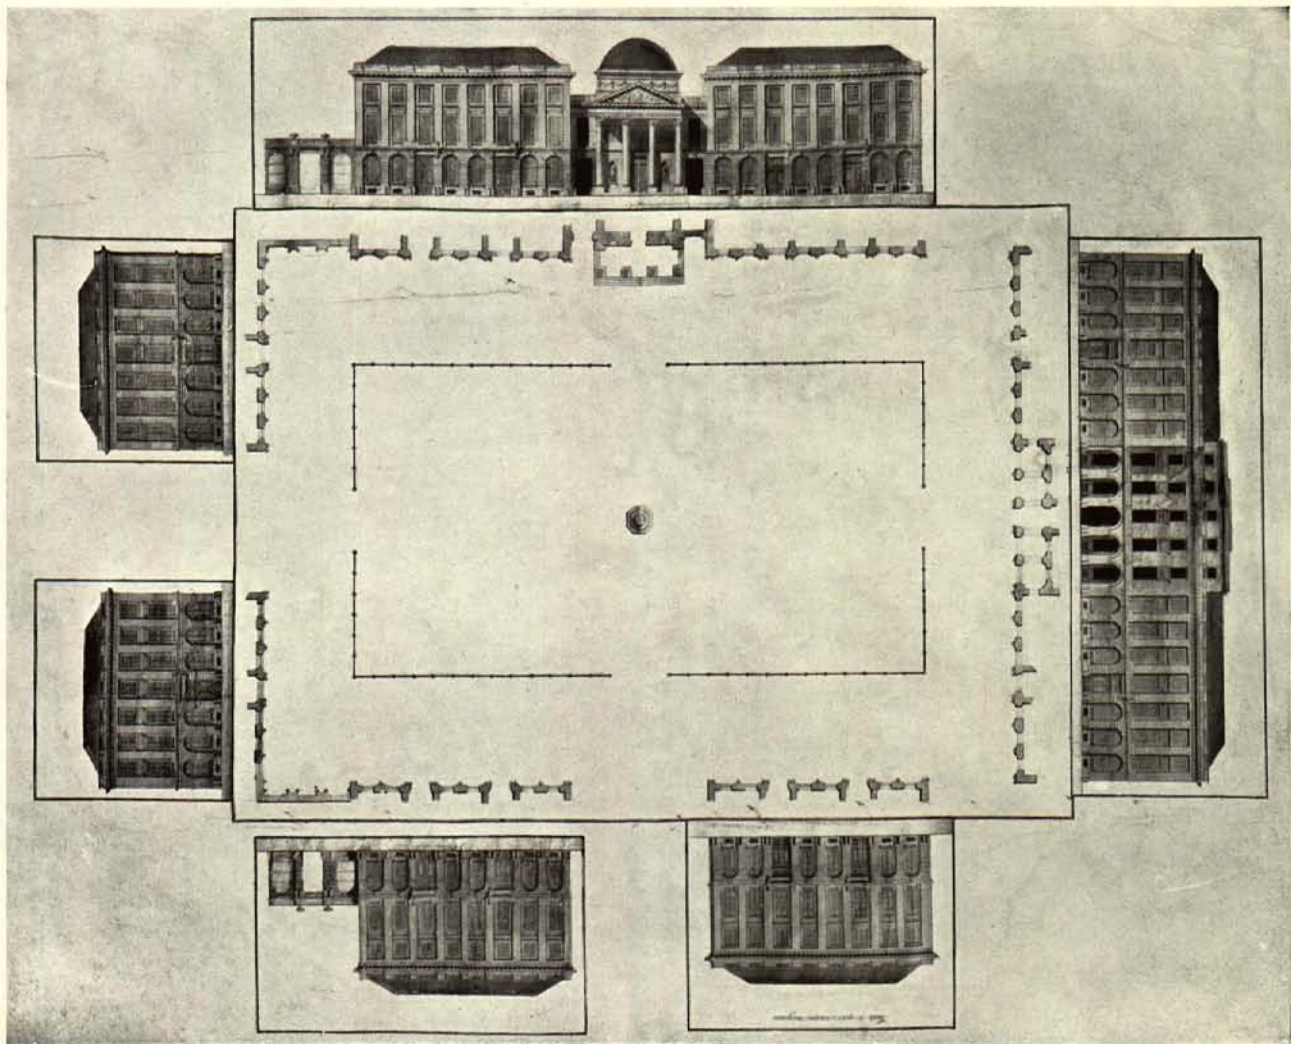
Plan d'ensemble de la place Royale, par l'architecte Earré, de Paris. Juillet-août 1775.
